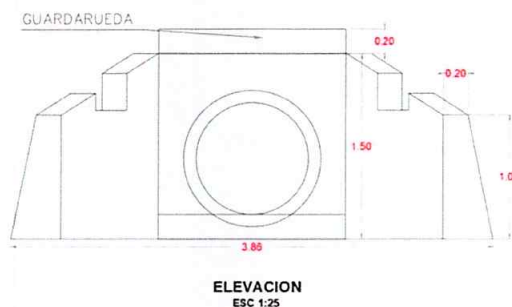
Sección en transversal de la estructura a diseñar tipo alcantarilla
